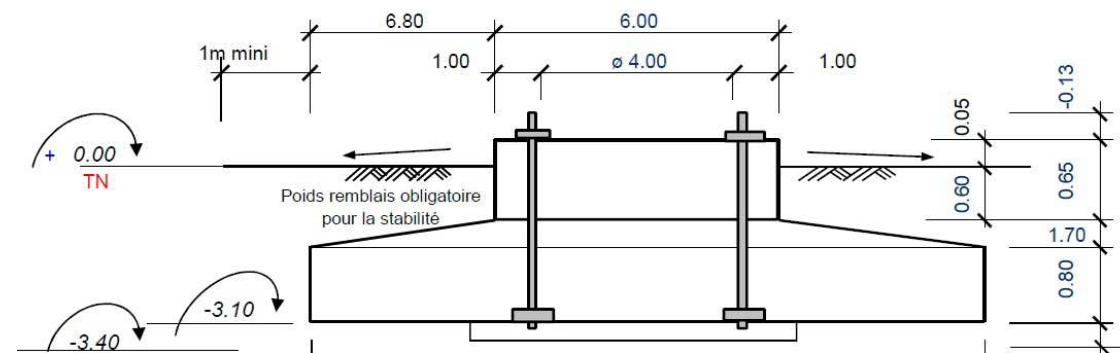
Schéma de principe d'une fondation d'éolienne Vestas
